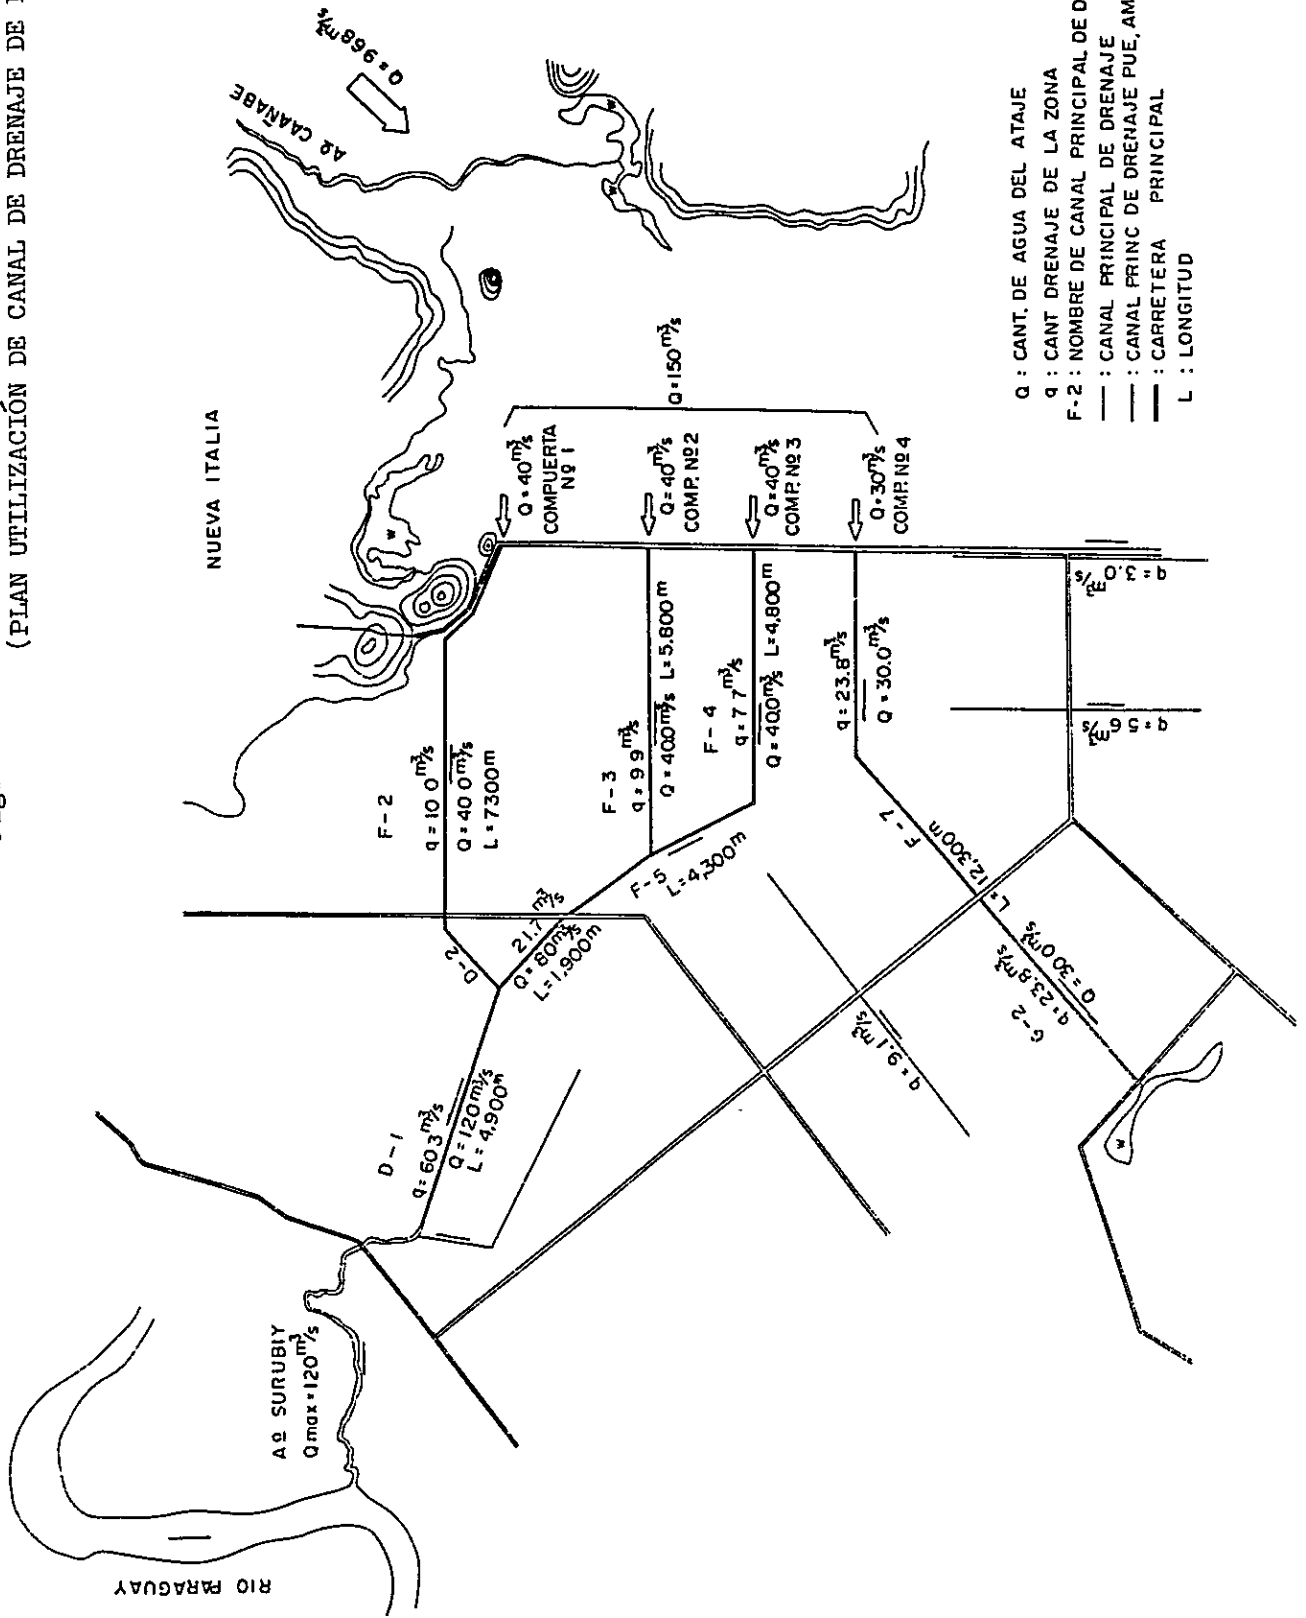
PLANO SISTEMACIO DE ARREGLO DE LA CANTIDAD DE DESAGUE
